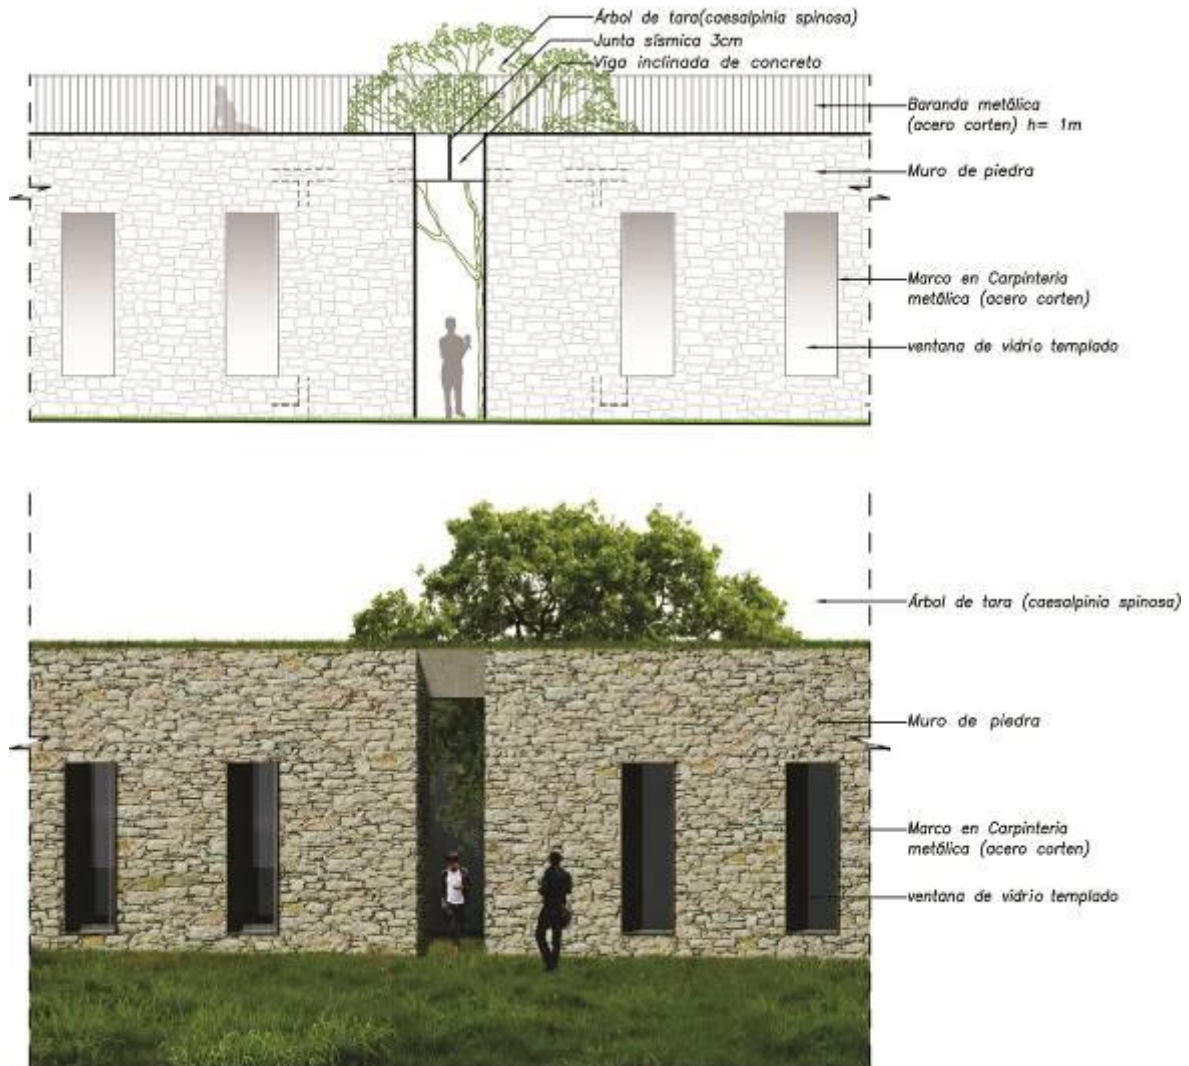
Plano esquemático de un sector de la elevación(arriba), imagen esquemática de las intenciones (bajo) Fuente: Elaboración propia
